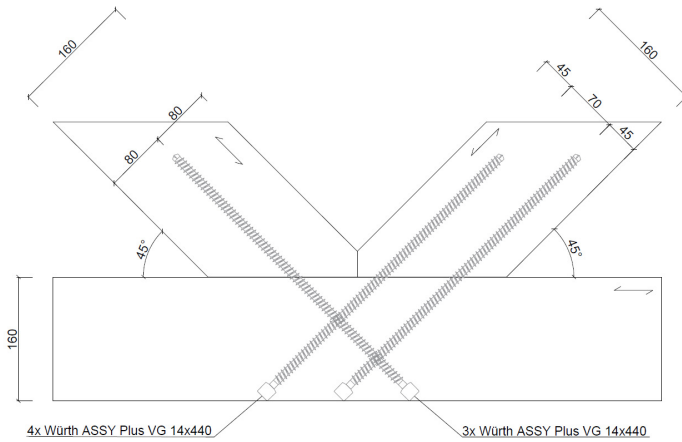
Knotendetail Träger VG-4, Maße in mm (Trägerbreite B = 160 mm).
